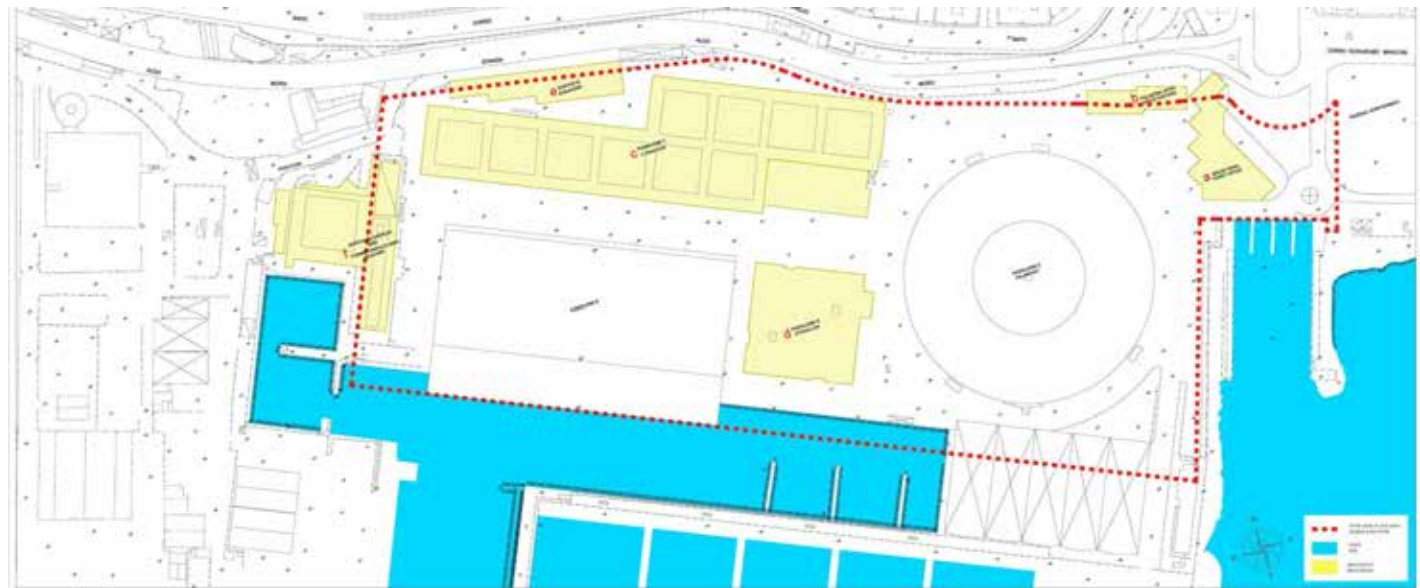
Planimetria generale dello stato di fatto con l'indicazione degli edifici da demolire
